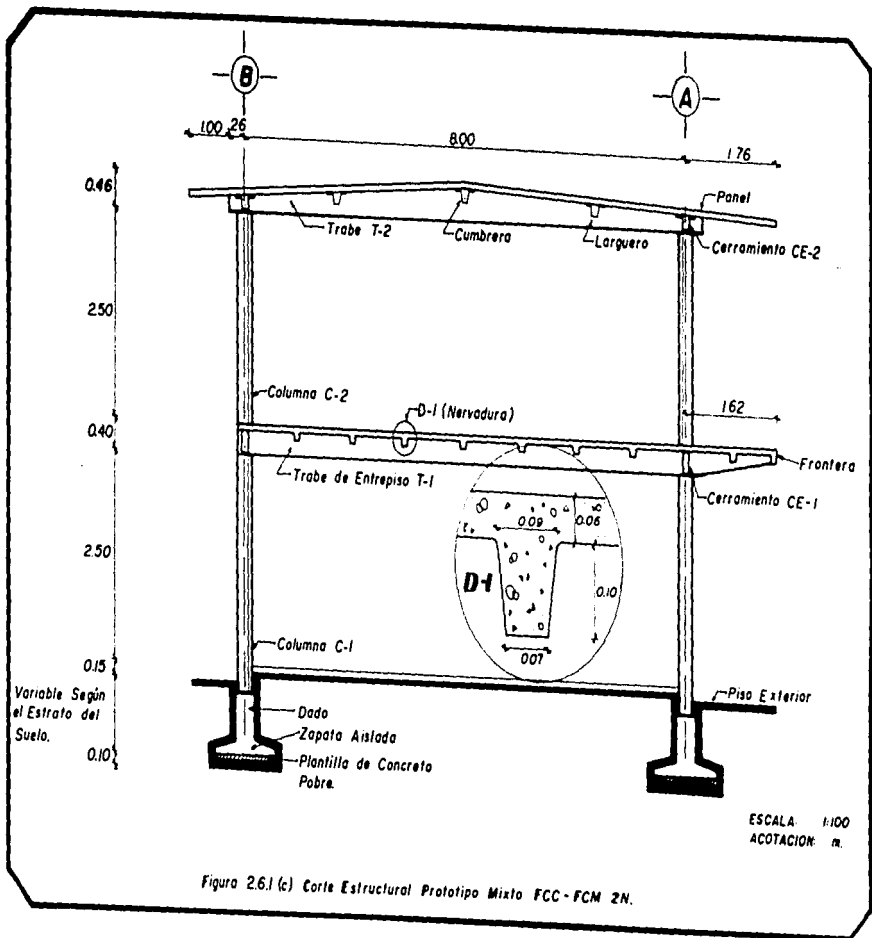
(c) Corte Estructural Prototipo Mixto FCC-FCM 2N.
